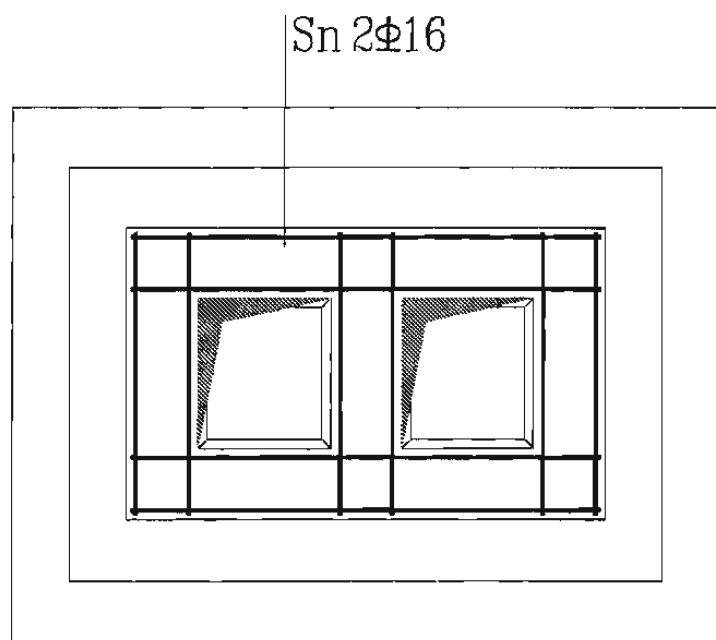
双杯口独立基础顶部焊接钢筋网示意
